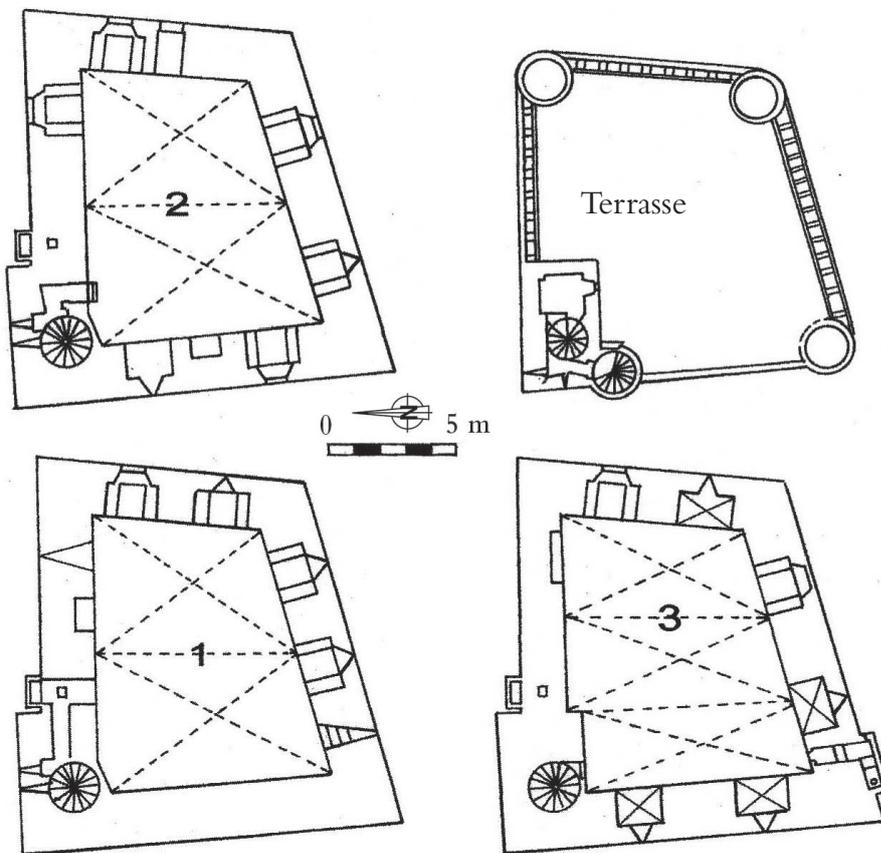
tour du pont d'Avignon. Plans des 3 niveaux plus terrasse. (relevés et dessin C.M.)
